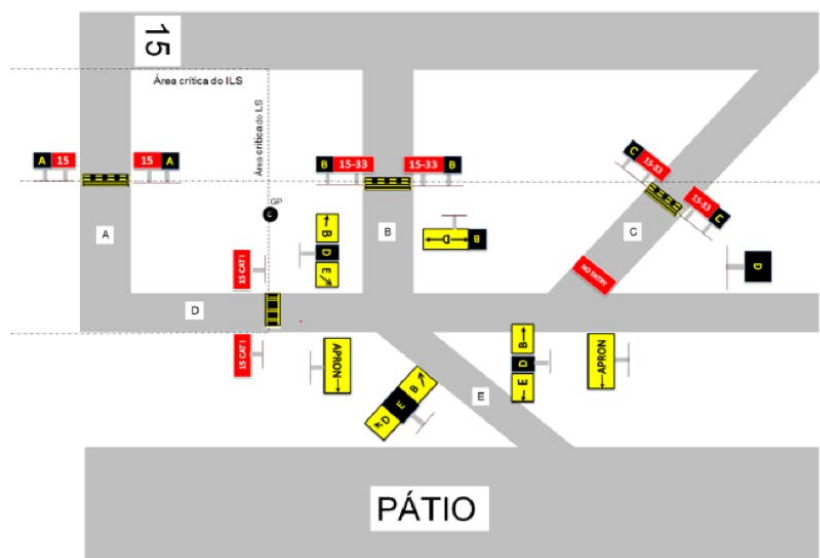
Configuração de sinalizações verticais (adaptado da AC 150/5340-18G)
